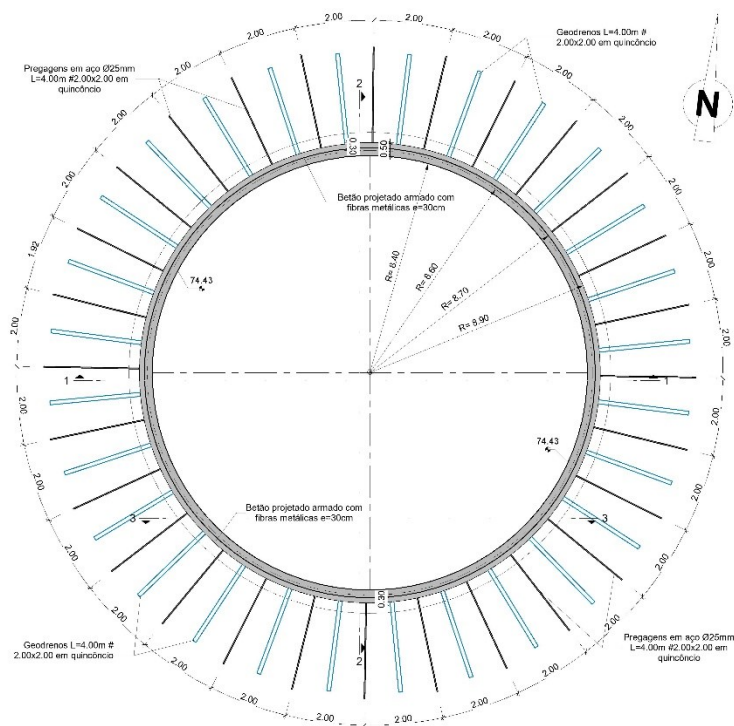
Planta tipo da solução de contenção provisória do poço PV215
